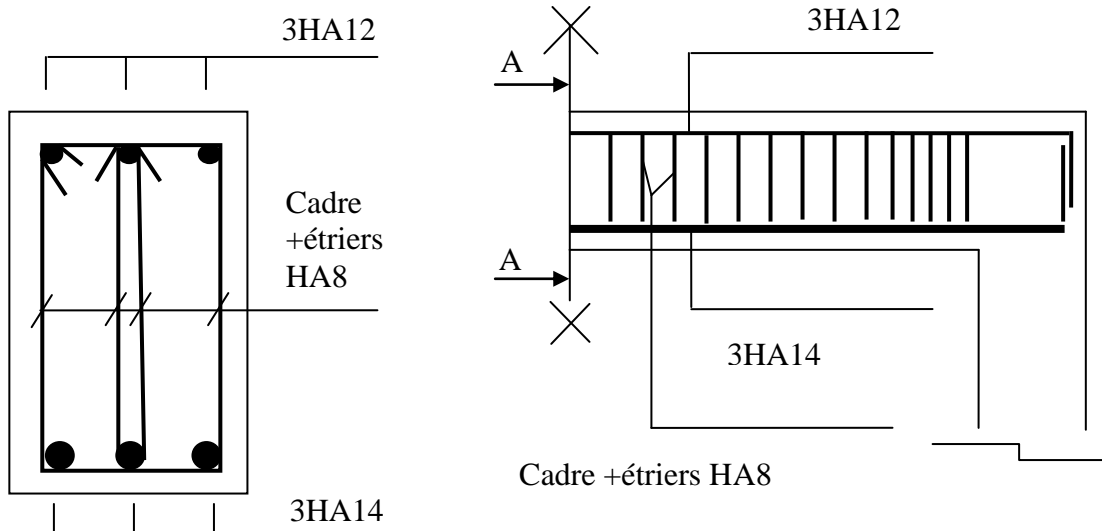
Schéma de ferrailage de la poutre palière.
